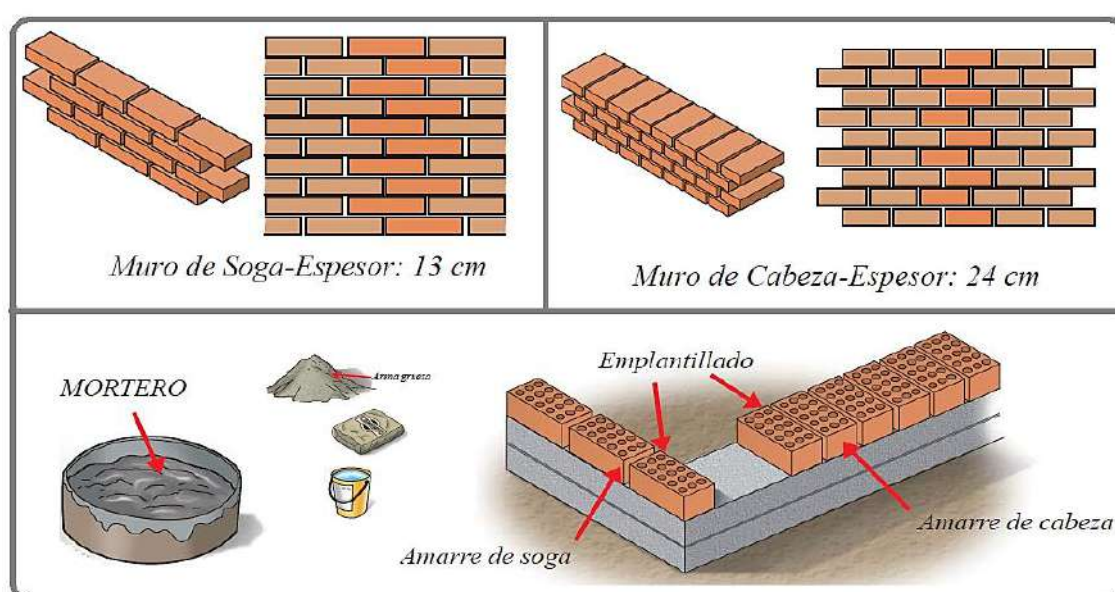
Tipos de asentado del ladrillo mas frecuentes en muros de albañilería.
